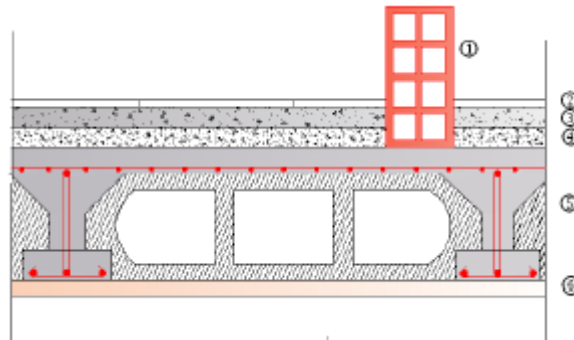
Coupe verticale d'un plancher terrasse inaccessible.
